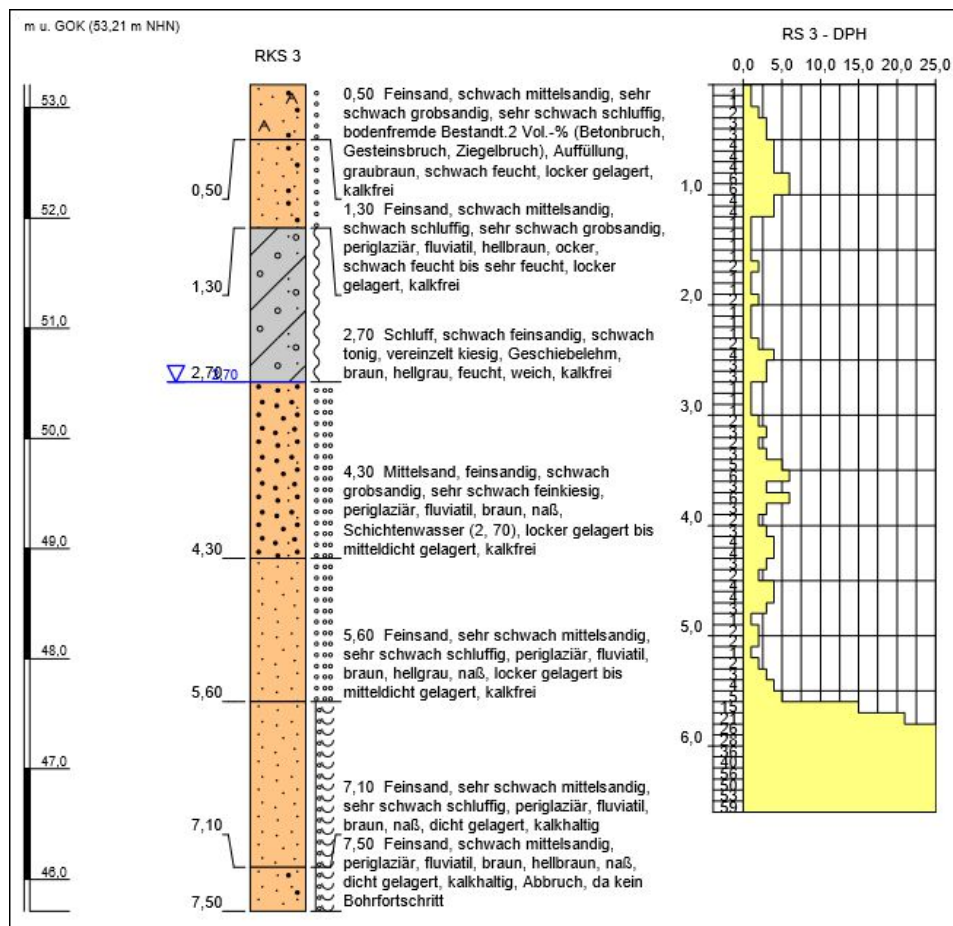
Typisches Bohrprofil mit Rammprotokoll im Bereich des Baufelds (RKS 3/RS3)
